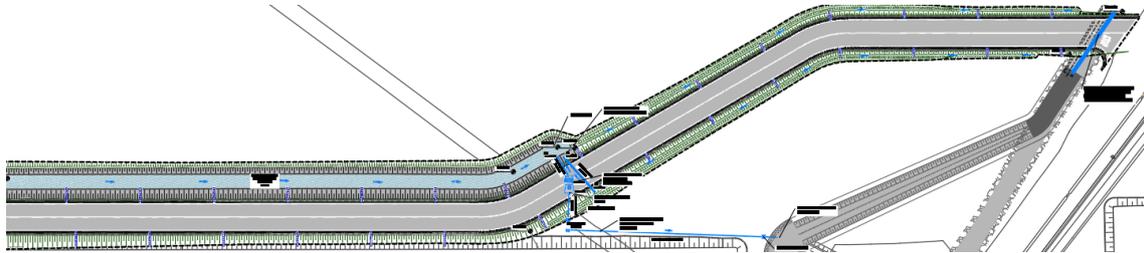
Estratto planimetrico dello stato di progetto – Individuazione dell'area oggetto di intervento con polilinea tratteggiata nera (piazzale e viabilità di accesso).
